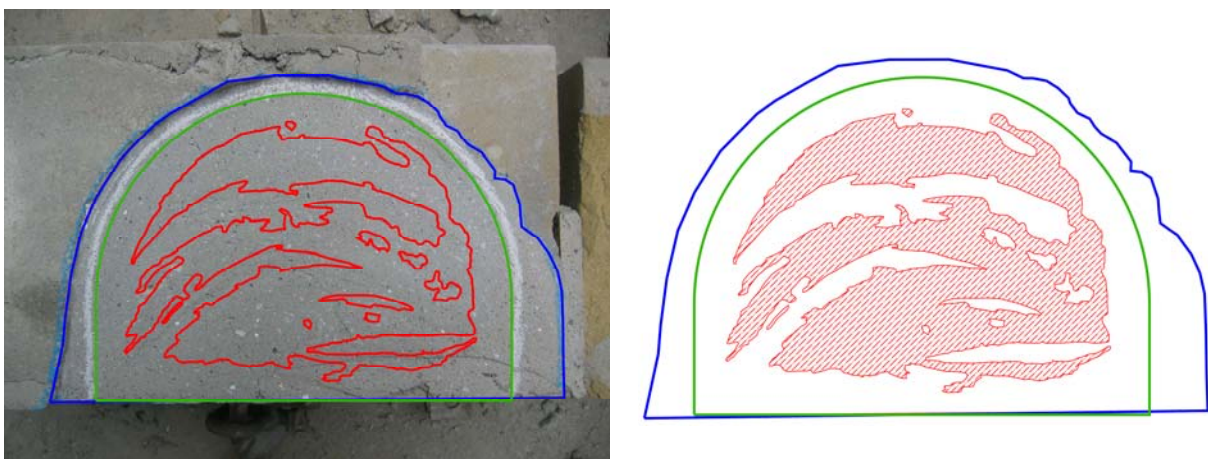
y 4.1.261: Replanteo del área de la roza (957.43 cm^2), el área del gato plano GPS-A Inferior (778.56 cm^2) y el área de contacto entre el gato plano del ensayo y el muro (345.73 cm^2).
